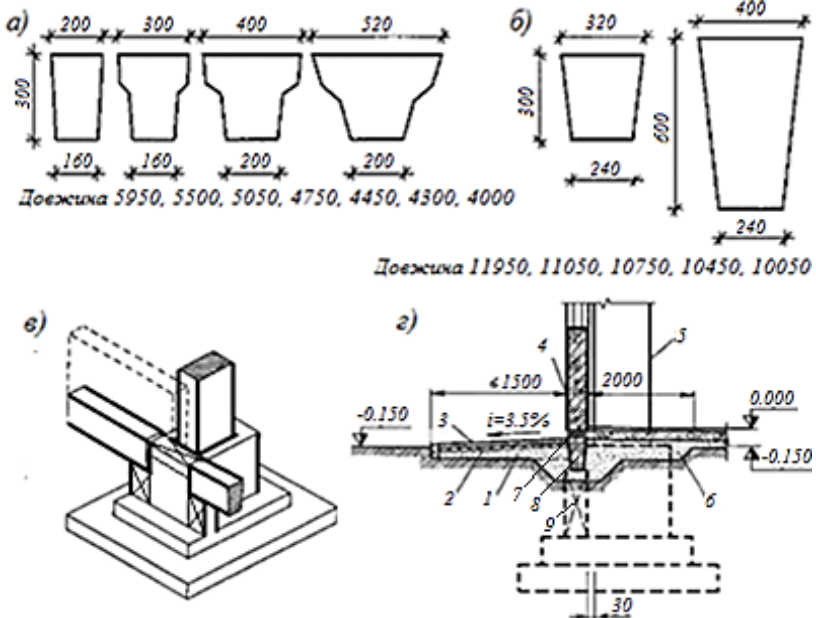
Фундаментні балки: а – переріз балок за кроку колон 6 м; б – те ж за 12 м; в, г – деталі спирання балок на фундамент; 1 – пісок; 2 – щебінь; 3 – асфальт; 4 – стіна; 5 – колона; 6 – шлак; 7 – гідроізоляція; 8 – балка; 9 – стовпчик
